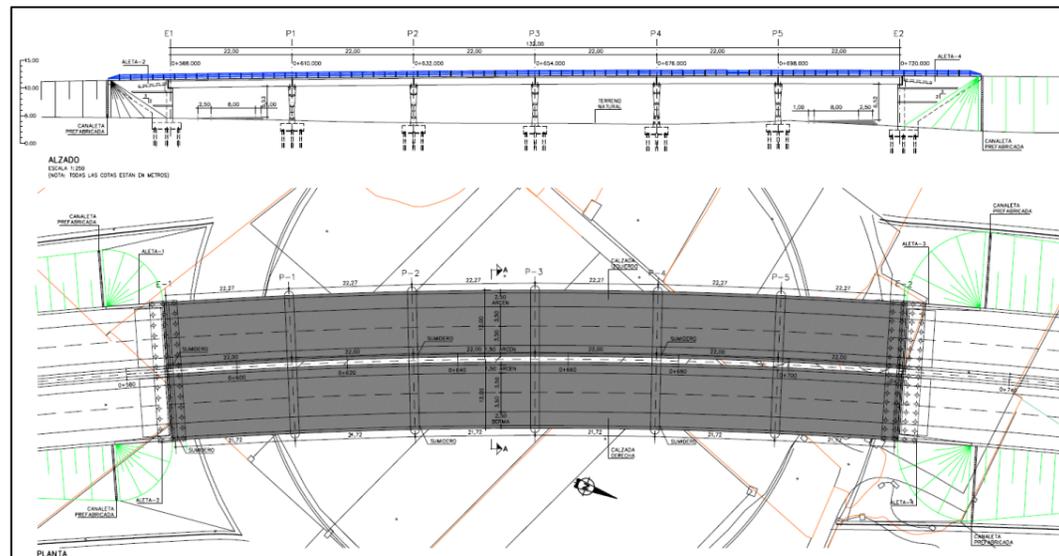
Alzado y planta viaducto sobre glorieta de Enlace de Favara
